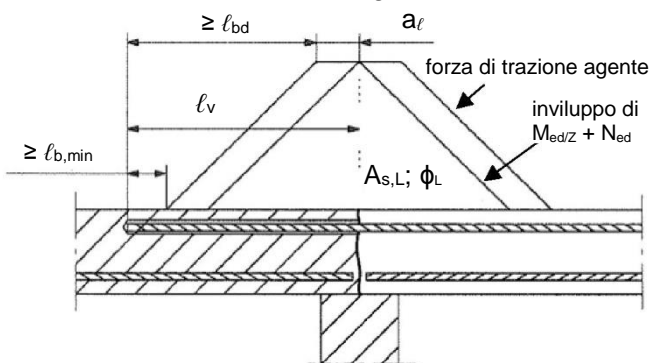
Giunto di sovrapposizione per connessioni con barre d'armatura tra lastre e travi
